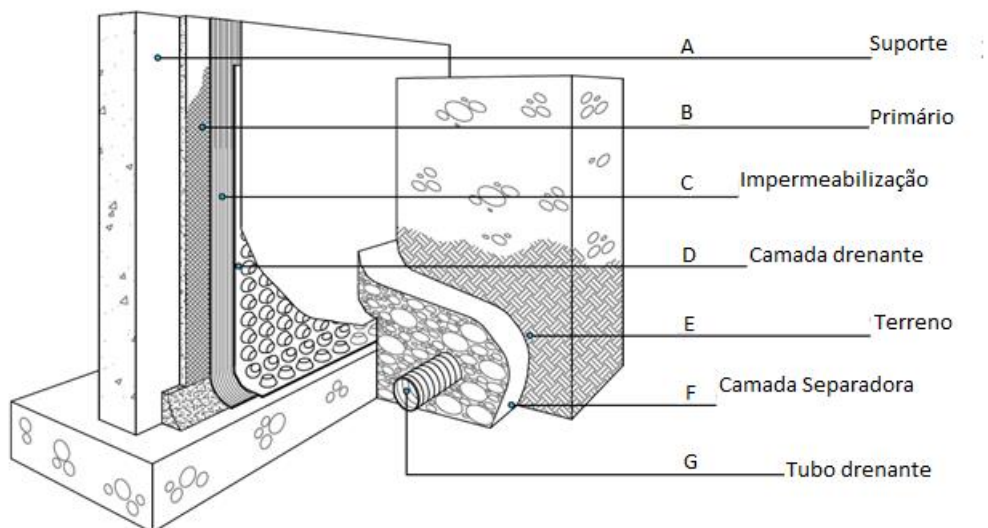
Solução de drenagem associada a muros de suporte de betão armado
